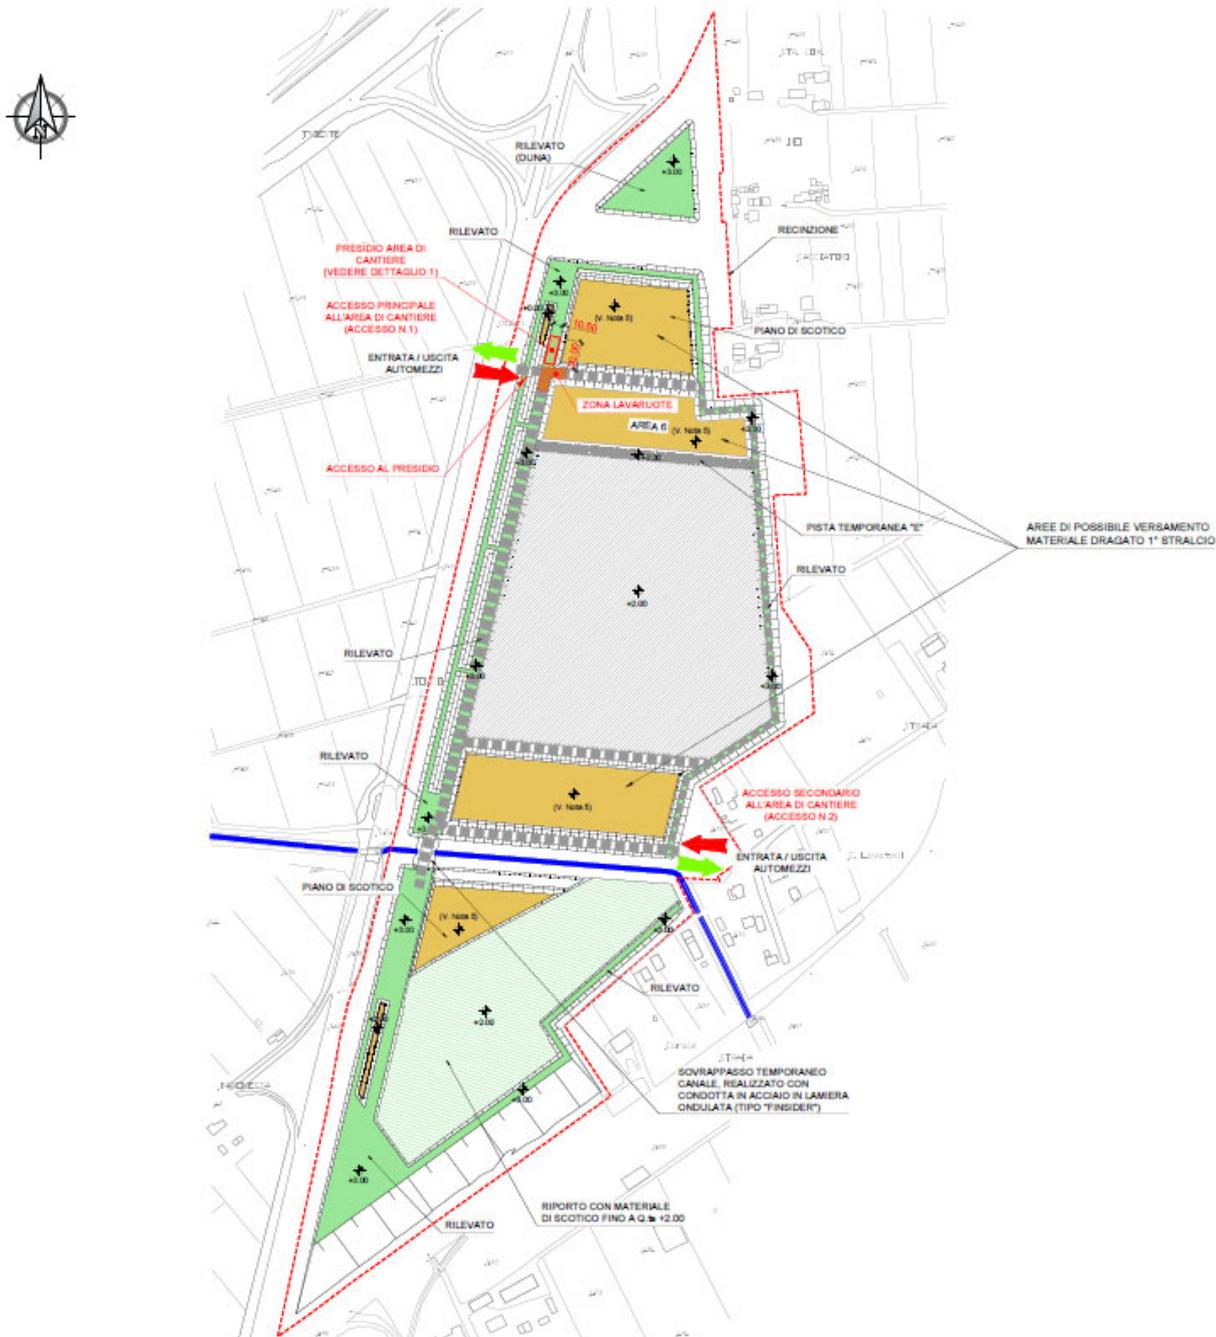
Area Logistica L2 – Stralcio planimetrico della predisposizione dell'areale a terra prima del riempimento con materiale di dragaggio
